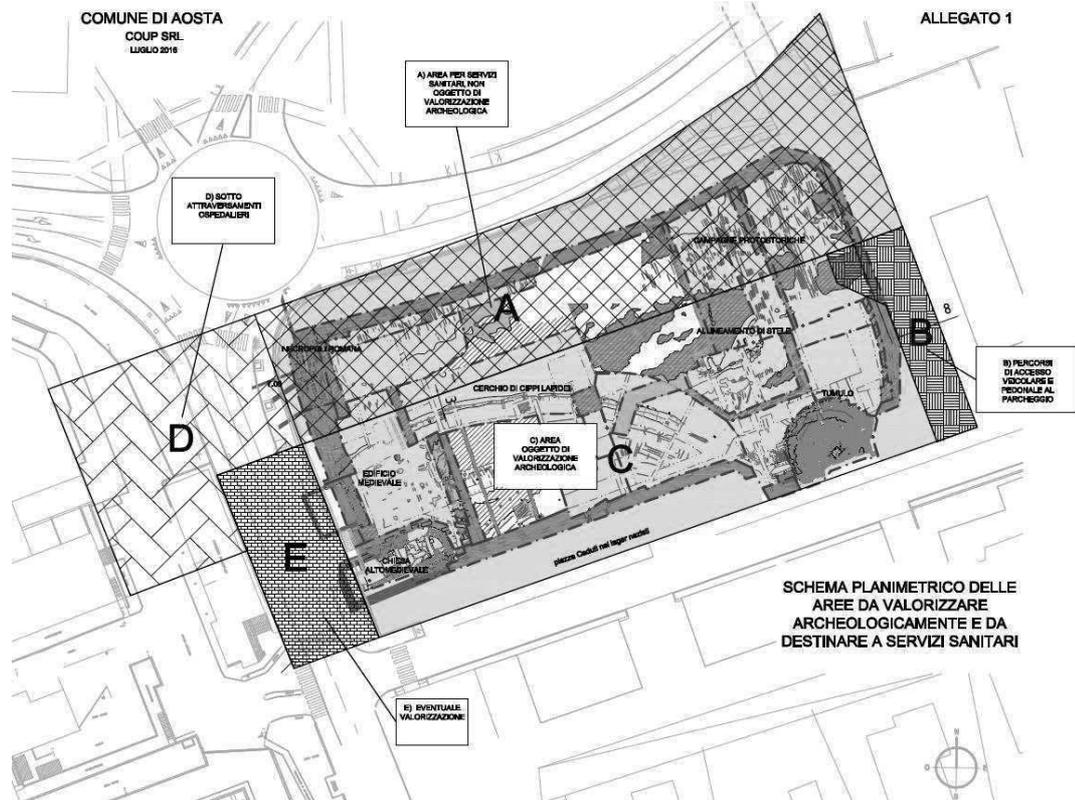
schema planimetrico aree scavi da completare o da valorizzare archeologicamente
